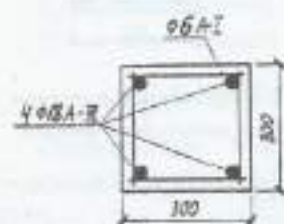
Армирование сечений колонн 5-го и 6-го этажей
